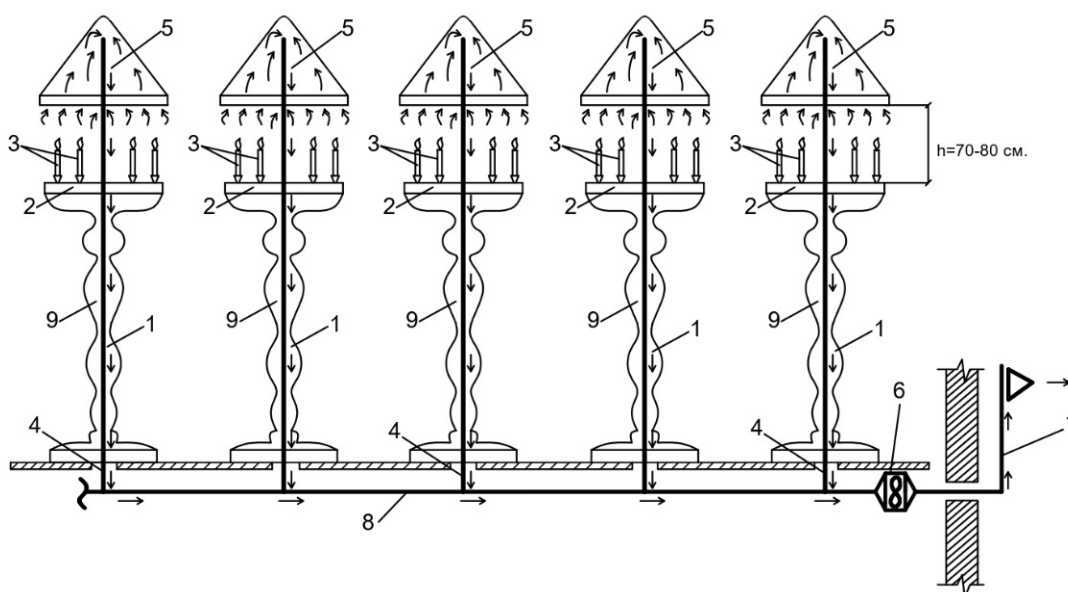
Схема местной вытяжной системы вентиляции с использованием вытяжных зонтов и нижней прокладкой магистрального воздуховода:
